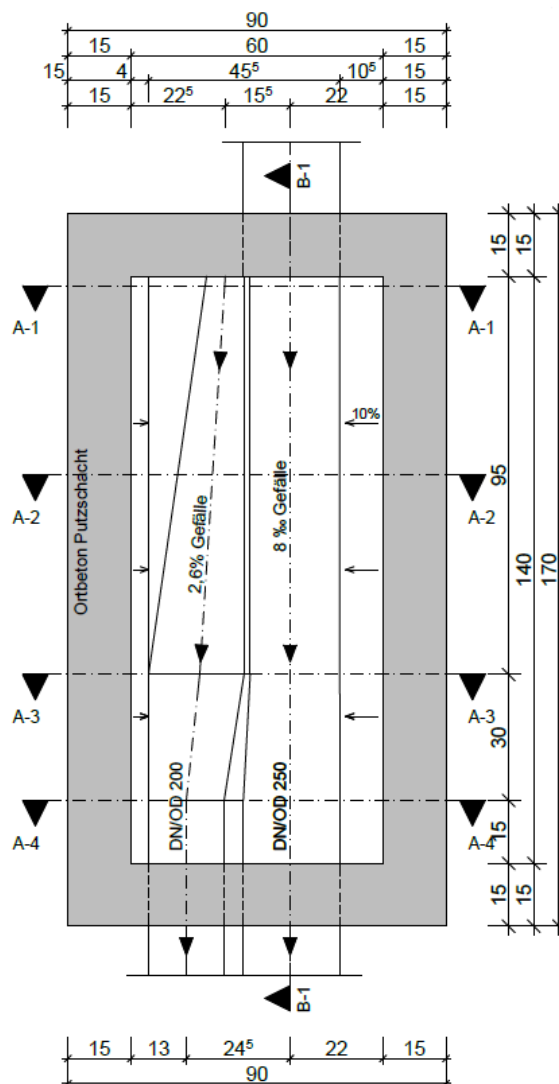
Ausführungsvorschlag Grundriss (Variante 5C)
